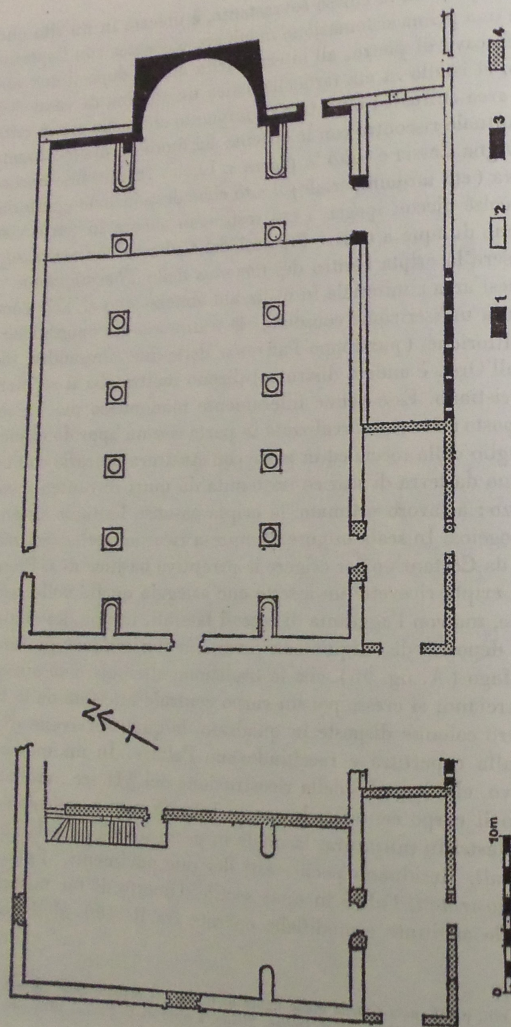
Planimetria generale della chiesa di s. Giovanni Evangelista.
